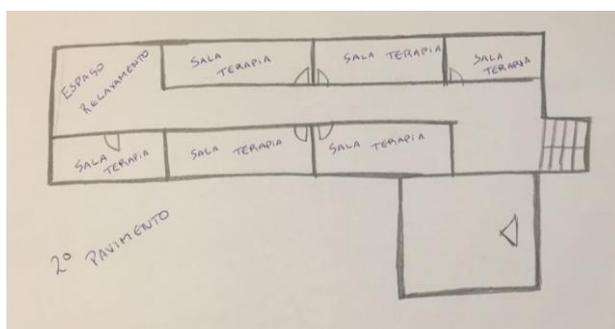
Croqui esquemático da planta baixa do 2º pavimento do Santé Spa.
